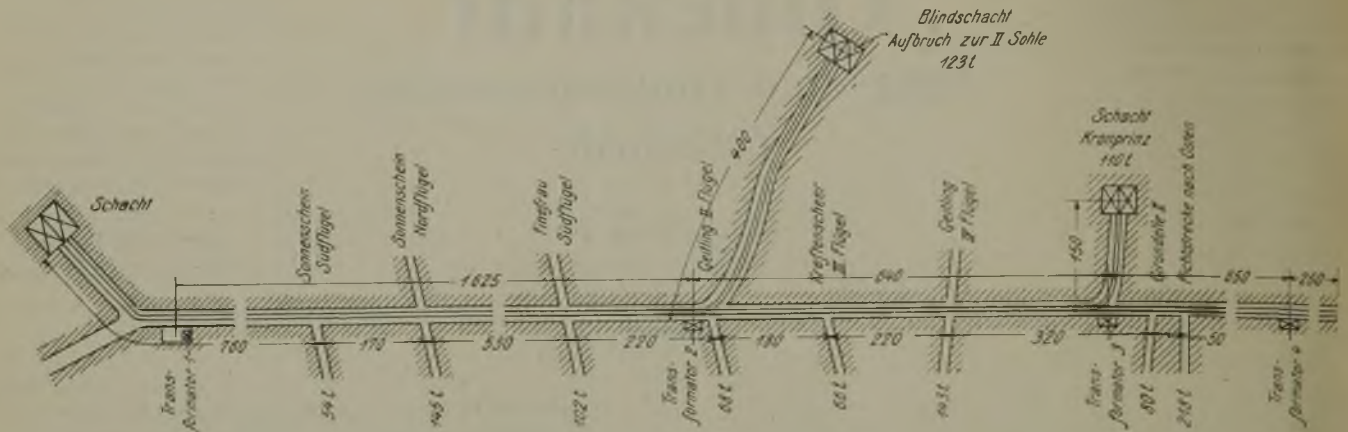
Grundriß des Hauptquerschlags mit den einzelnen Anschlagpunkten.
